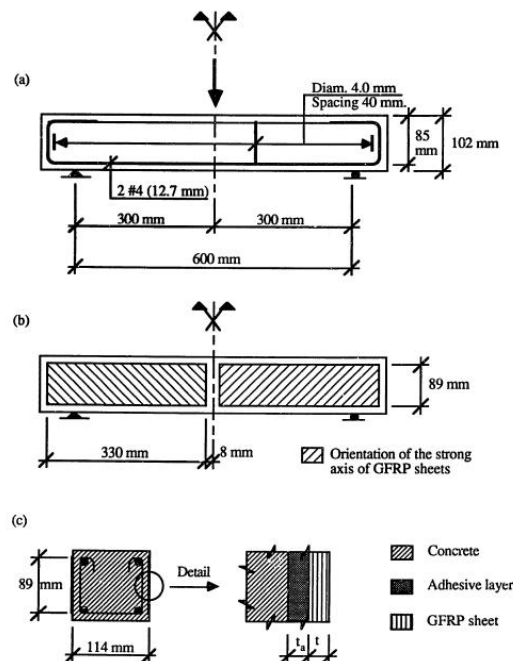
Geometría y disposición de barras y refuerzos en las vigas ensayadas por Berset.
